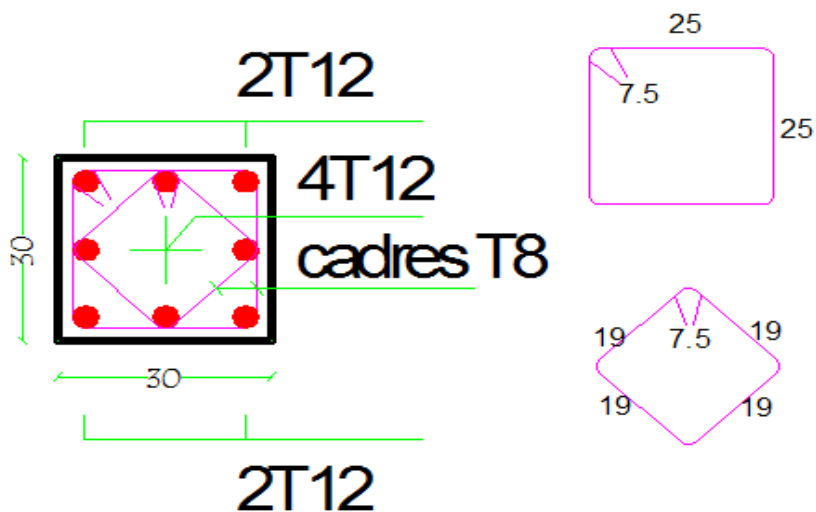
Schéma de ferrailage du poteau^{4^{eme}}, 5^{eme}, toiture.
